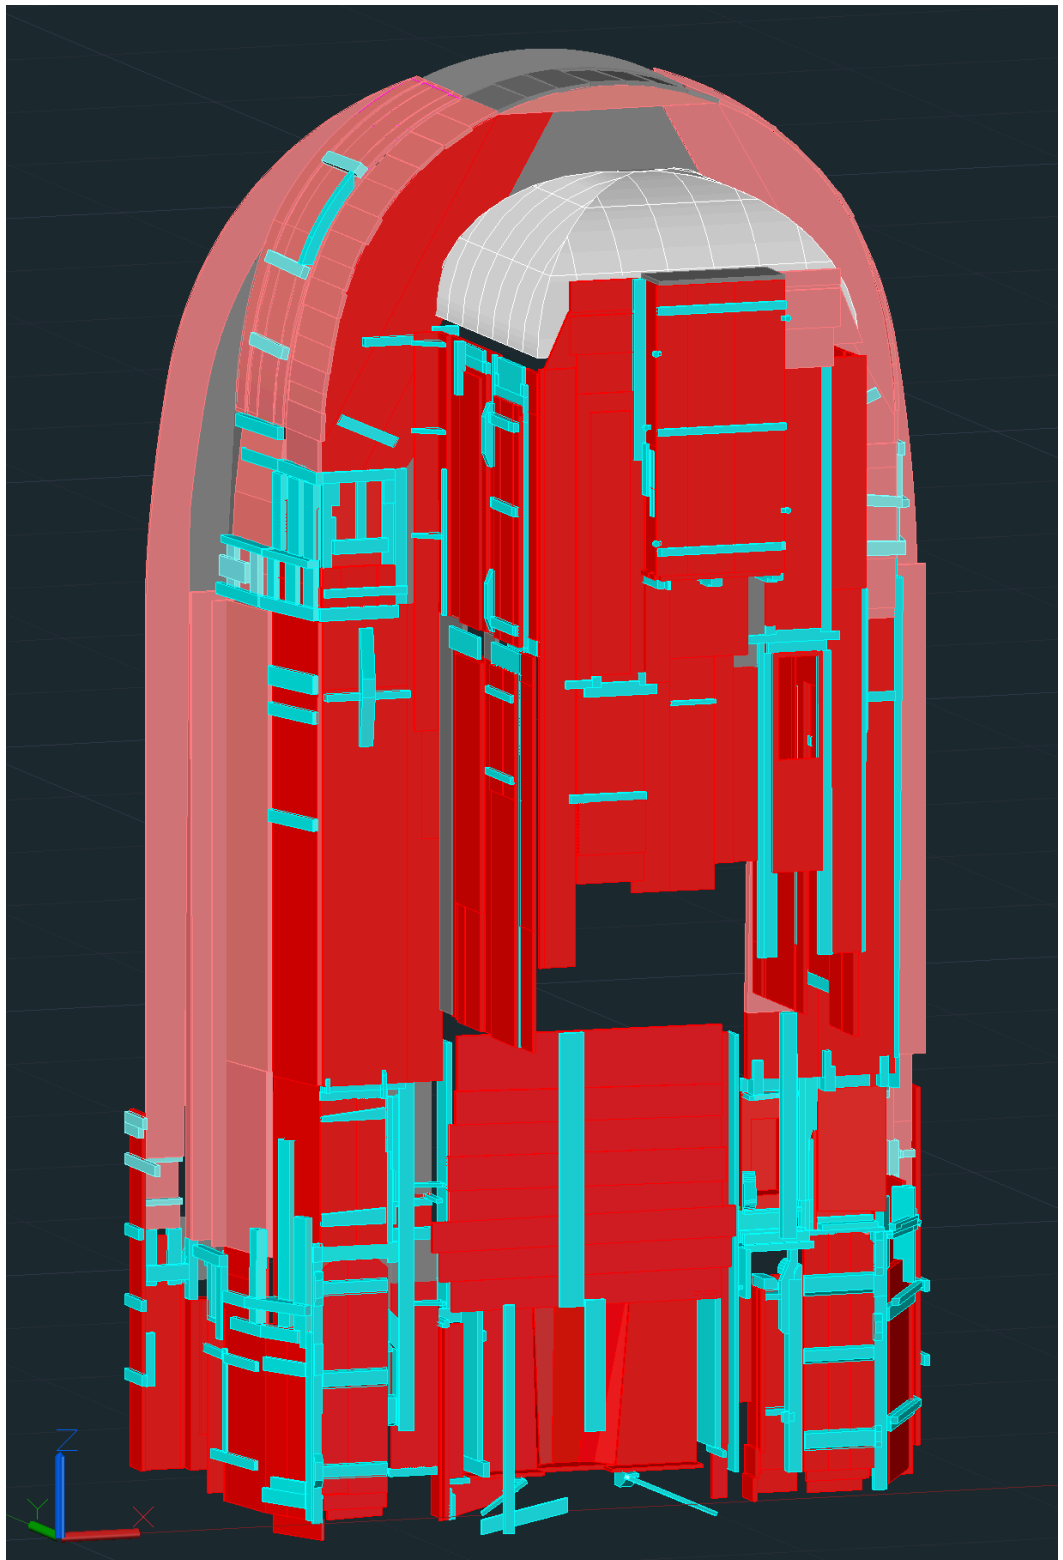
Desenho AutoCAD 3D, elementos de união - vista lado da Epístola
